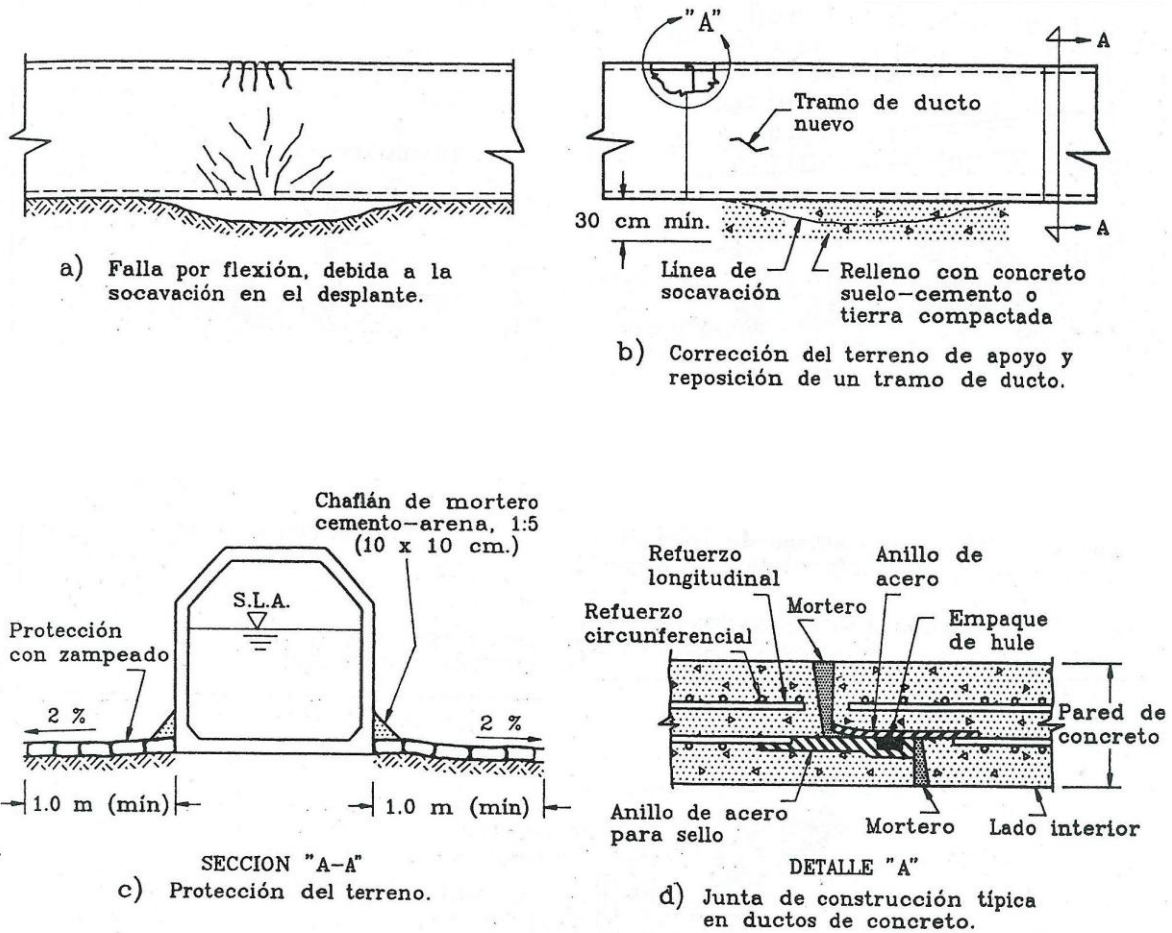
Reconstrucción de un tramo fallado de cajón de concreto (CFE, 1991)
